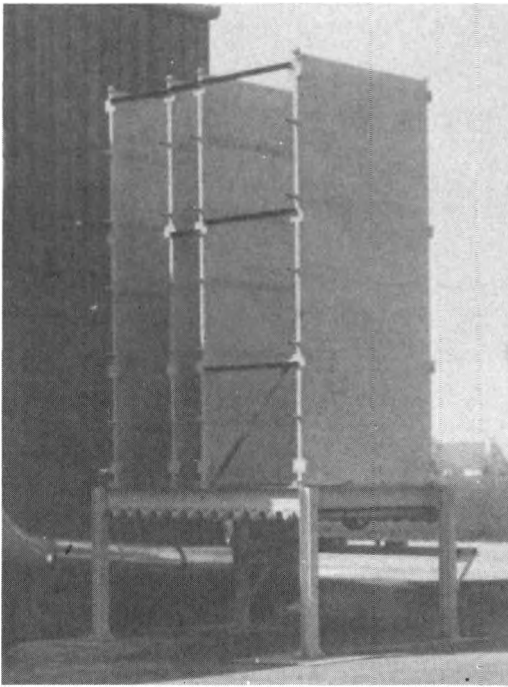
De fire vandkammerelementer er på plads på bundrammen.
